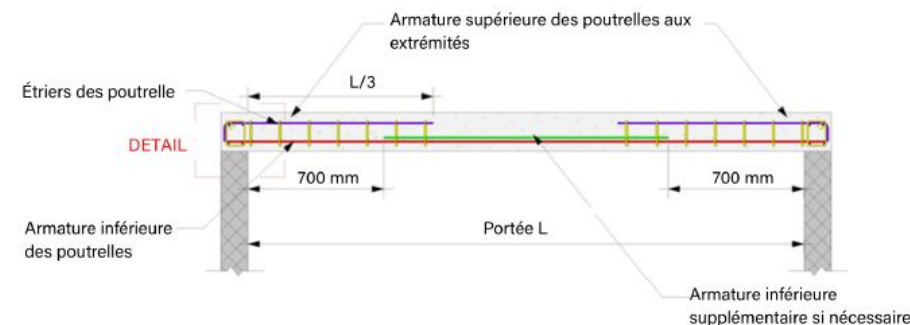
Armature des poutrelles de portée simple
